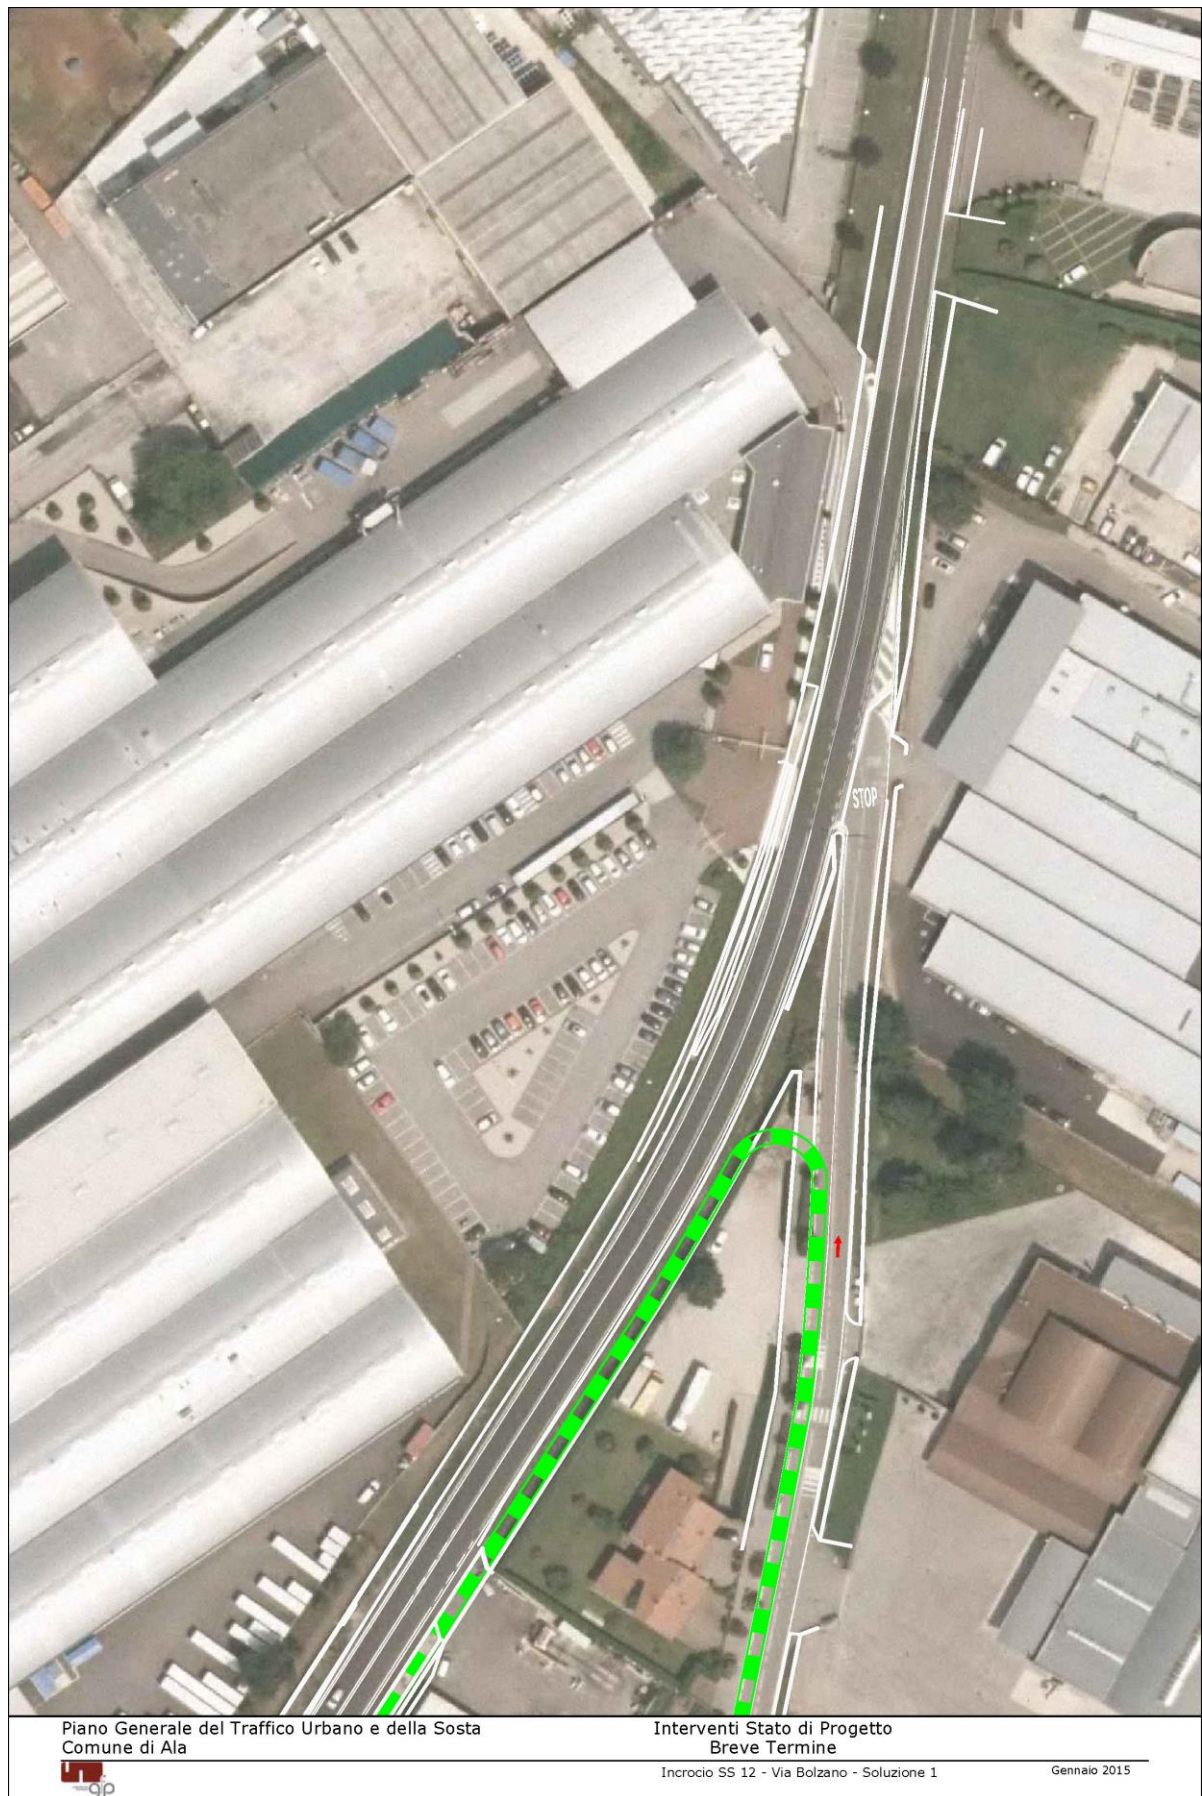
Interventi Stato di Progetto - Breve Termine - Incrocio S.S. 12-via Bolzano - Soluzione 1
